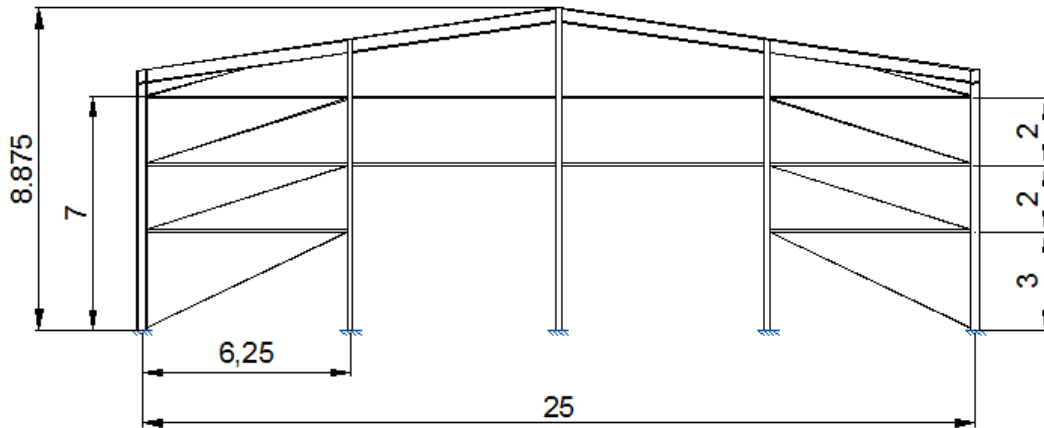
Alçat de les façanes frontals (vista dels pilars).
